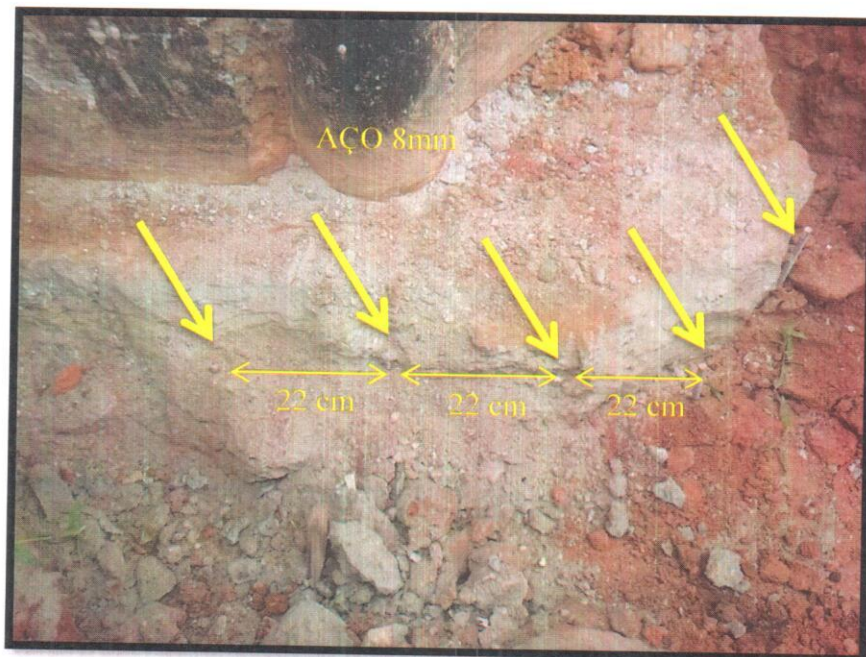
Planta de Fundação (Escarificação na Sapata P8 e P13)
